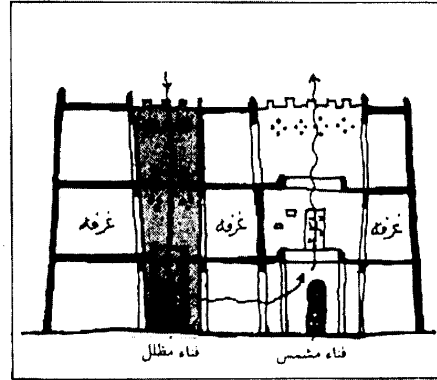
مسقط أفقي منزل السحيمي موضحاً عليه حركة
